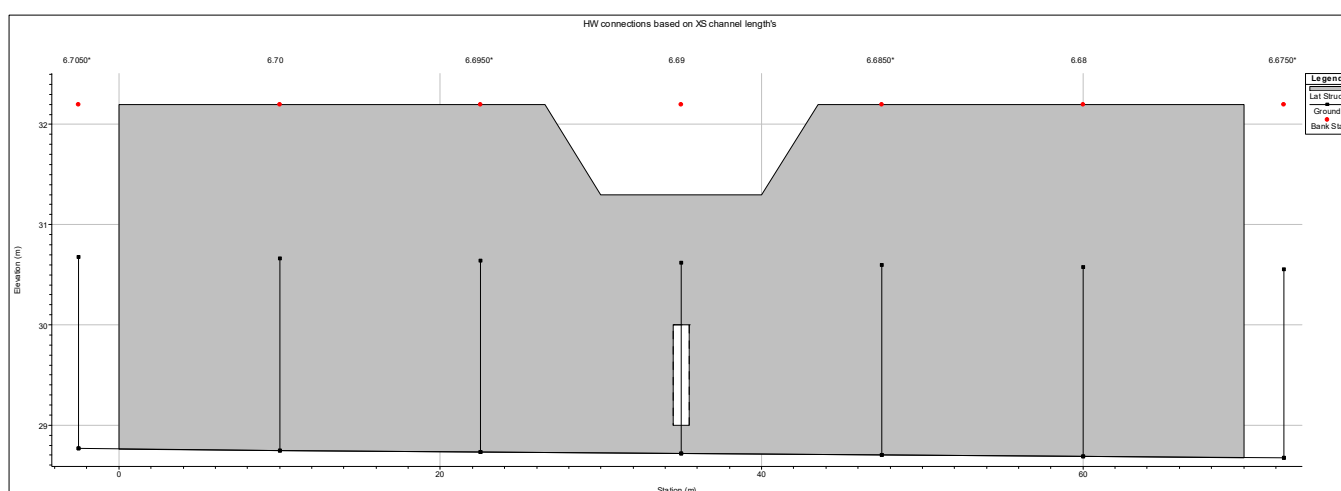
Stramazzo di restituzione al canale Lorno e scarico di fondo della cassa. Sezioni 33-34.
